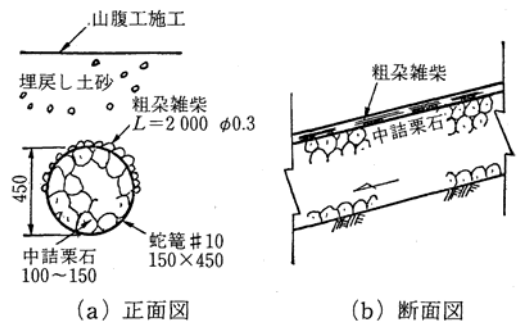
蛇籠暗渠工の例 (単位 : mm)
